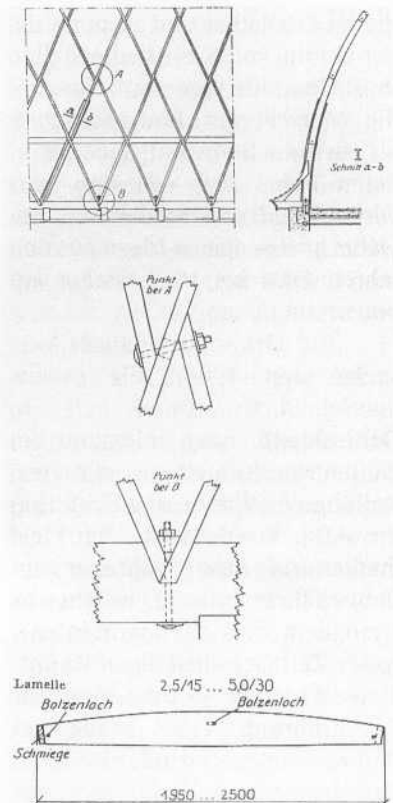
Konstruktionsprinzip Zollbau-Lamellen-Dach
